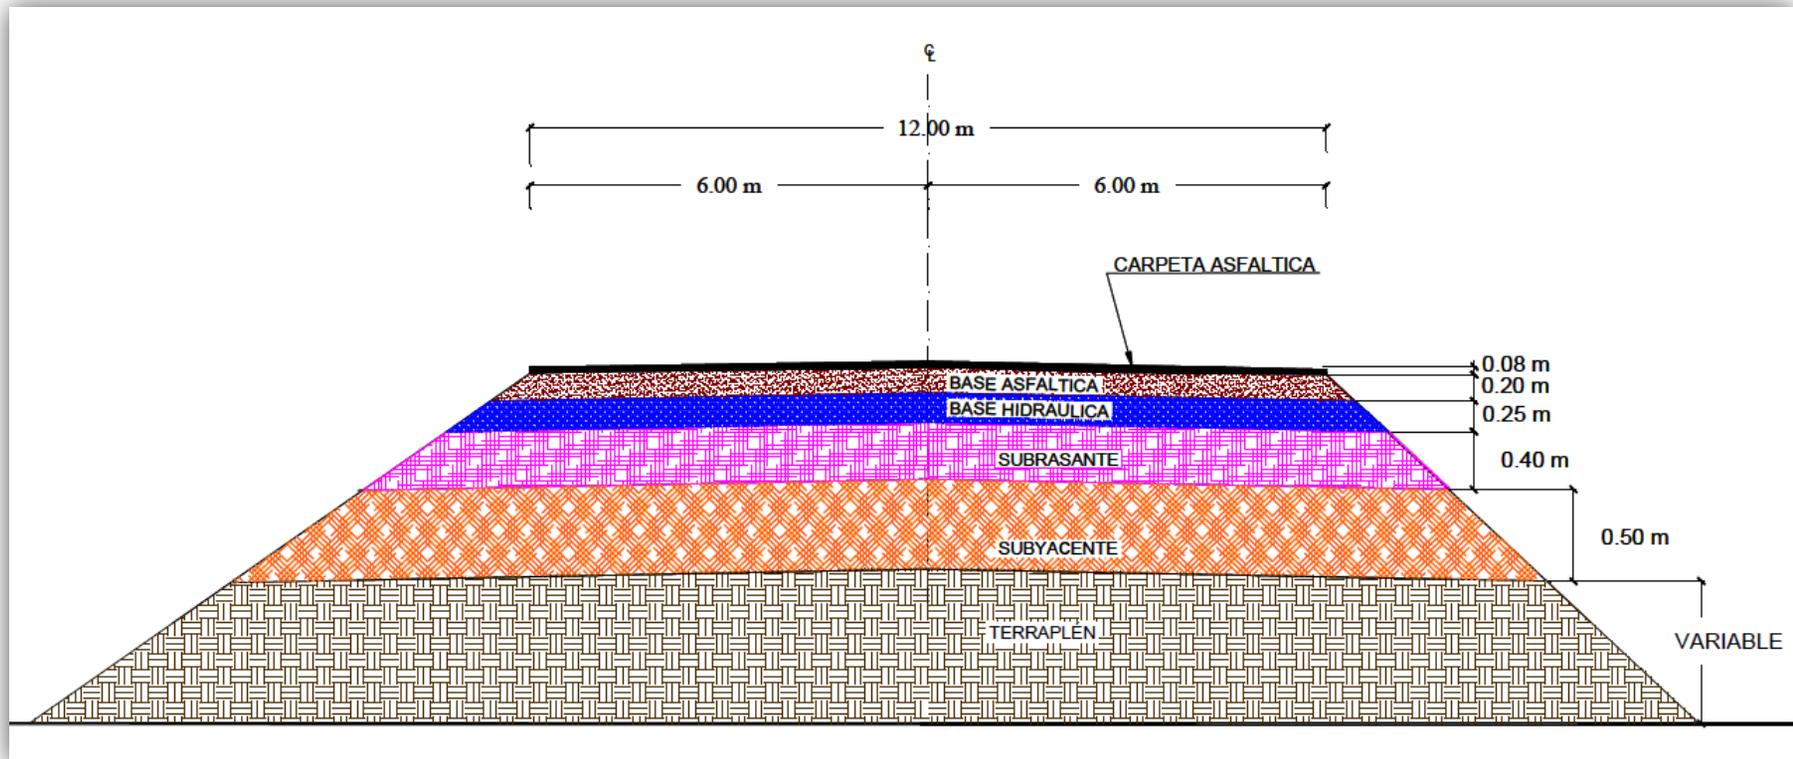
Estructura de pavimento para el Circuito Exterior de Culiacán
